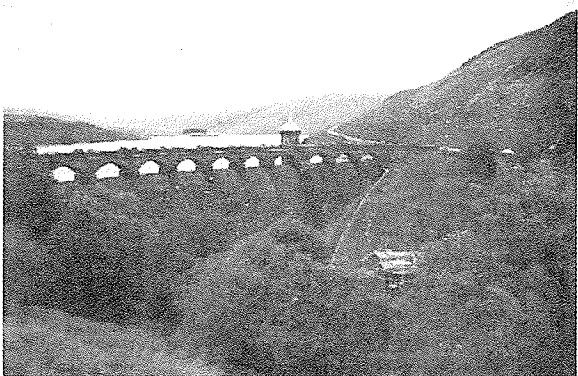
Craig Goch Dam(Elan Valley)(撮影: 著者)
